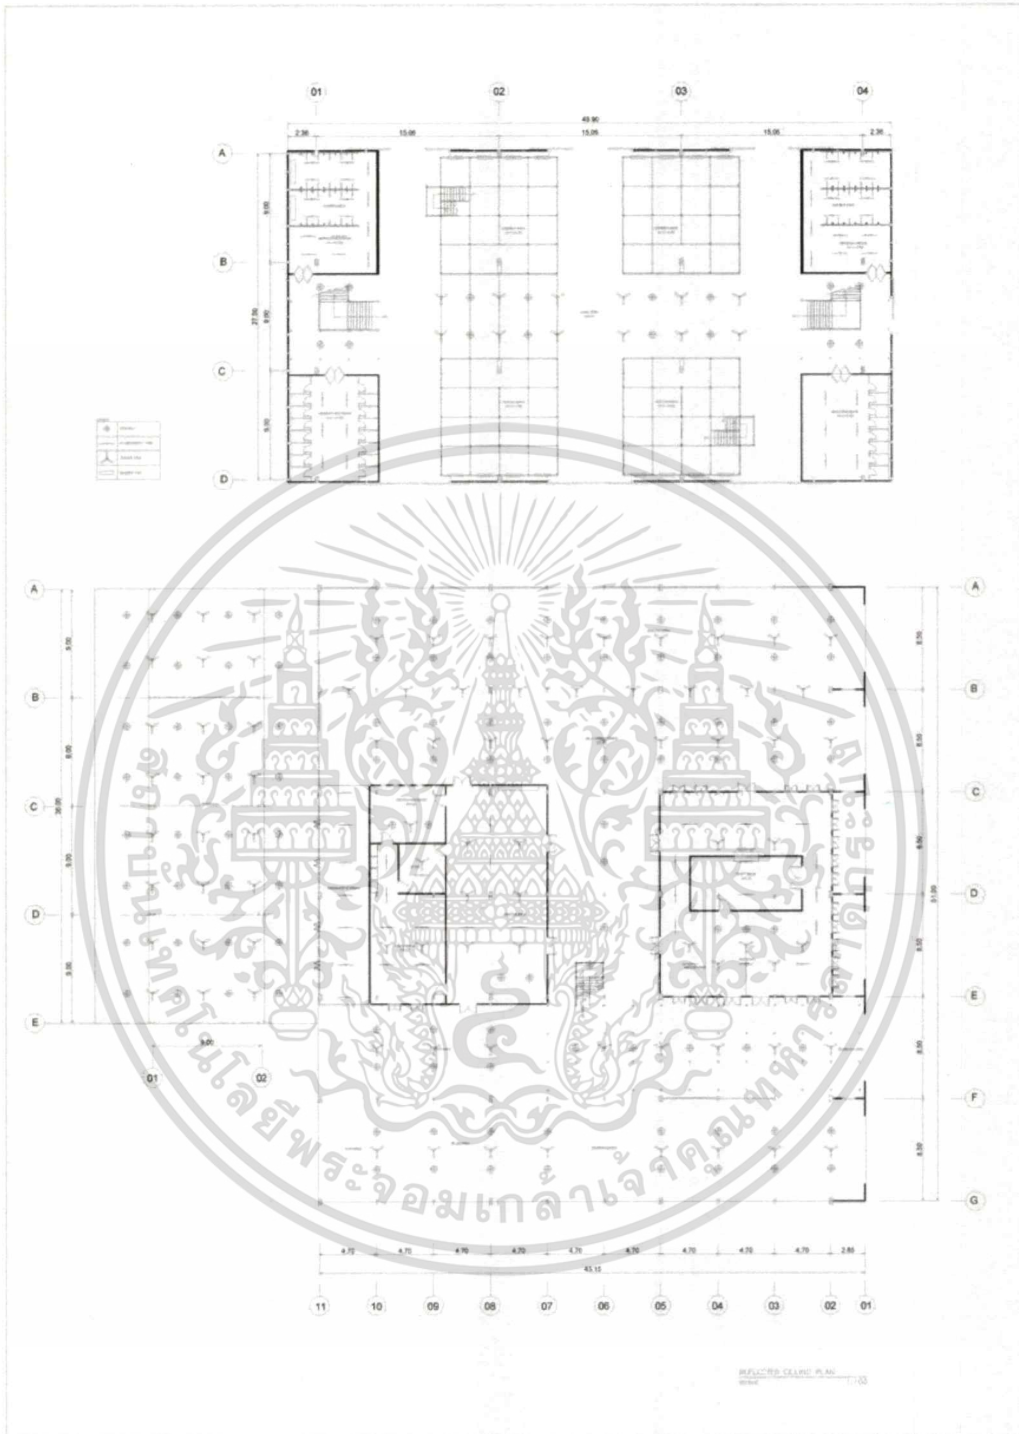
แสดงผังบริเวณภายในชั้นลอย อาคารหลัก(MAIN BUILDING MEZZANINE FLOOR PLAN)
